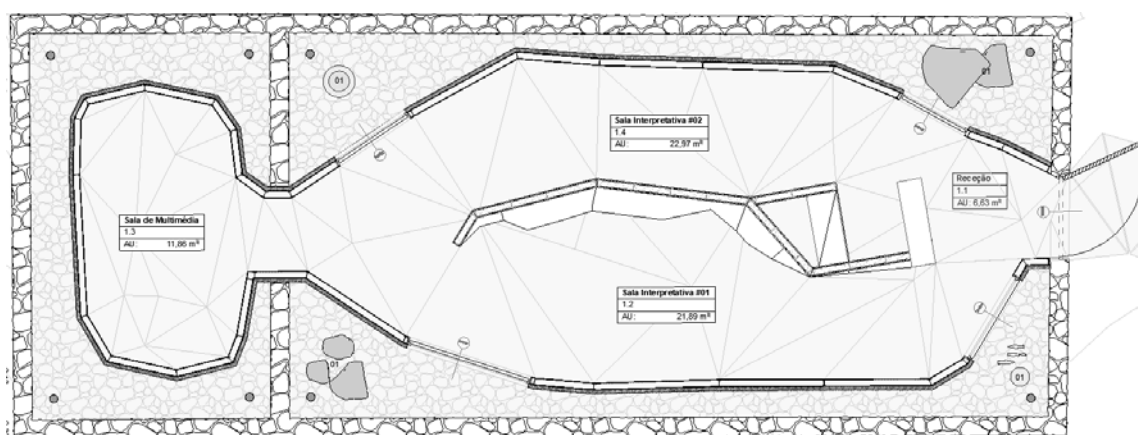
Planta Piso 0 Centro de Interpretação (sem escala).
